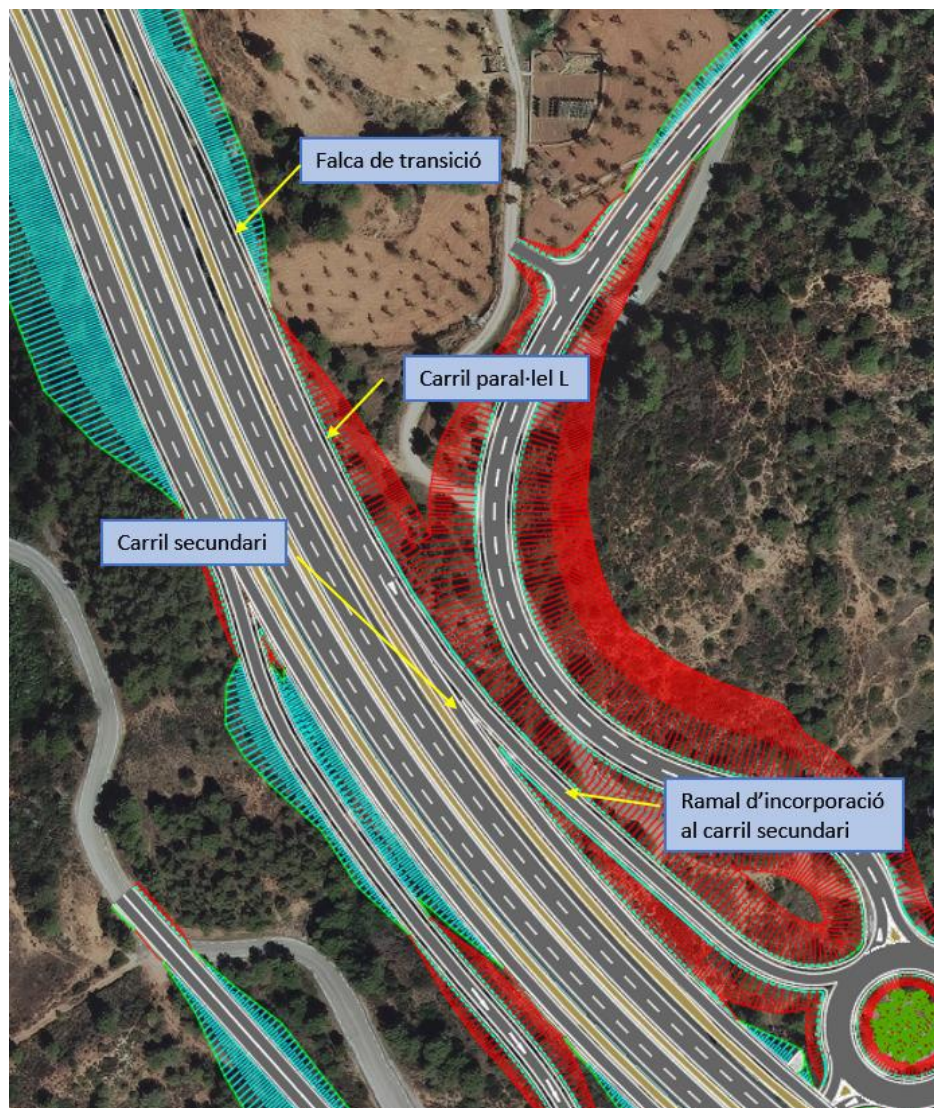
Detall en planta dels ramals d'incorporació al carril secundari.
